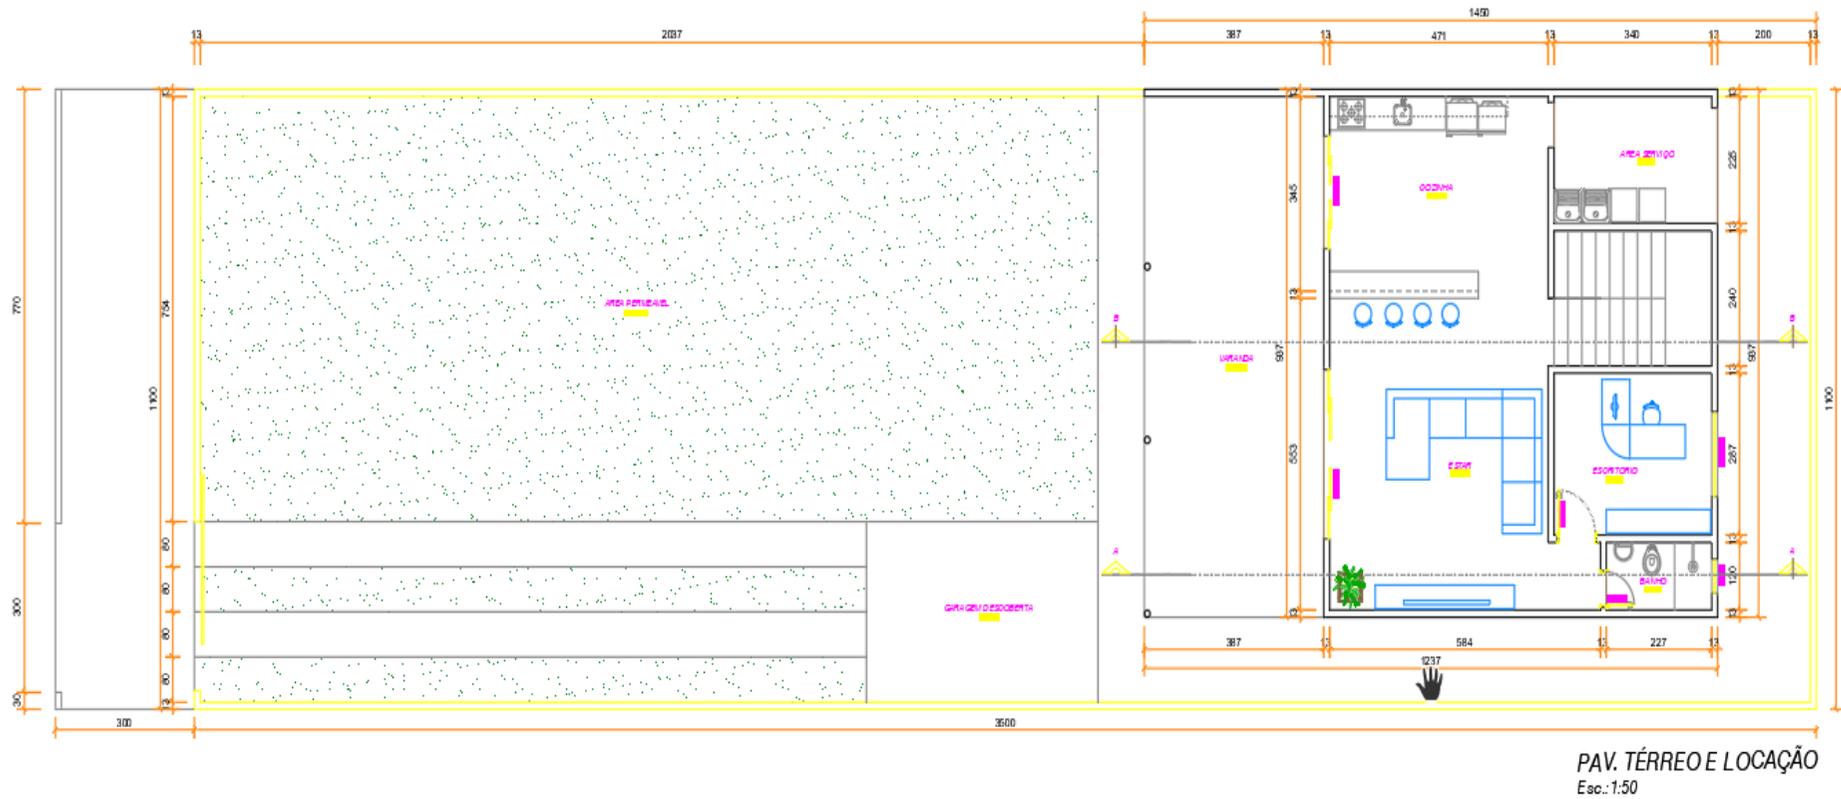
Planta Pavimento Térreo Projeto Arquitetônico
